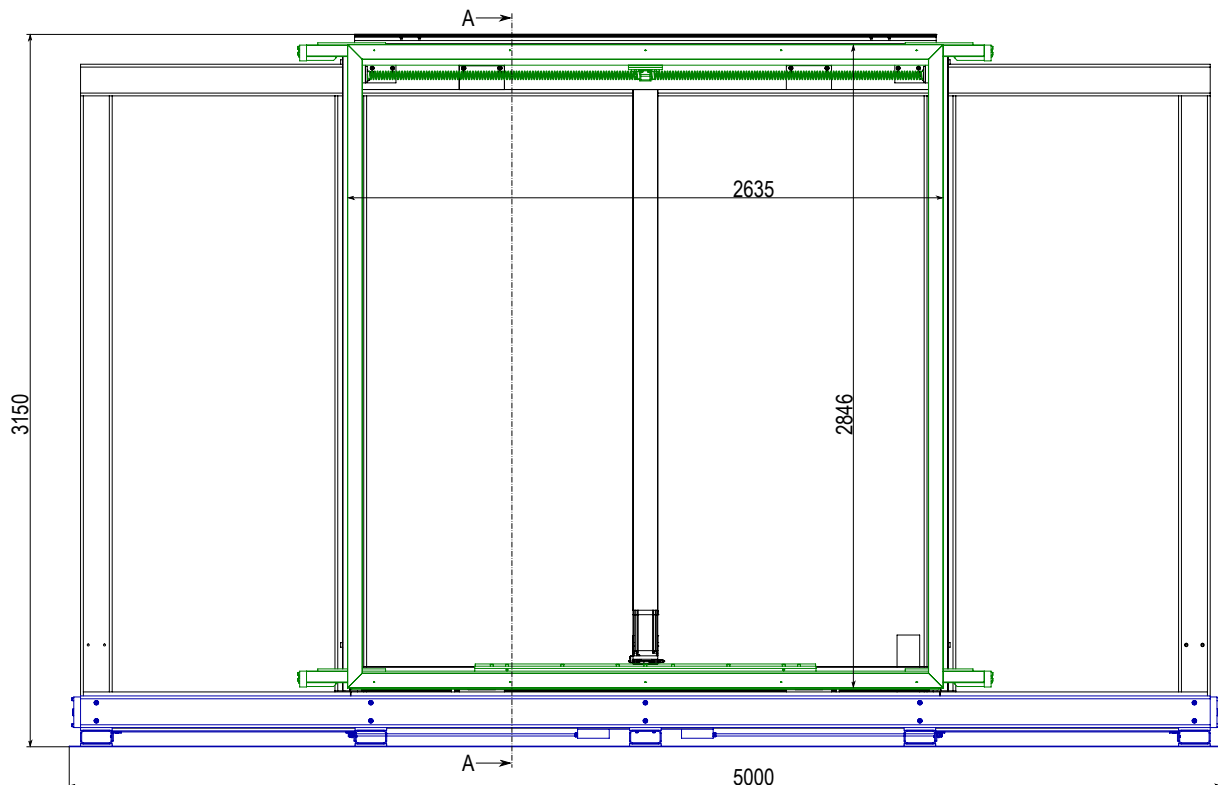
Frontalansicht der beweglichen Doppelfassade auf dem Prüfstand
